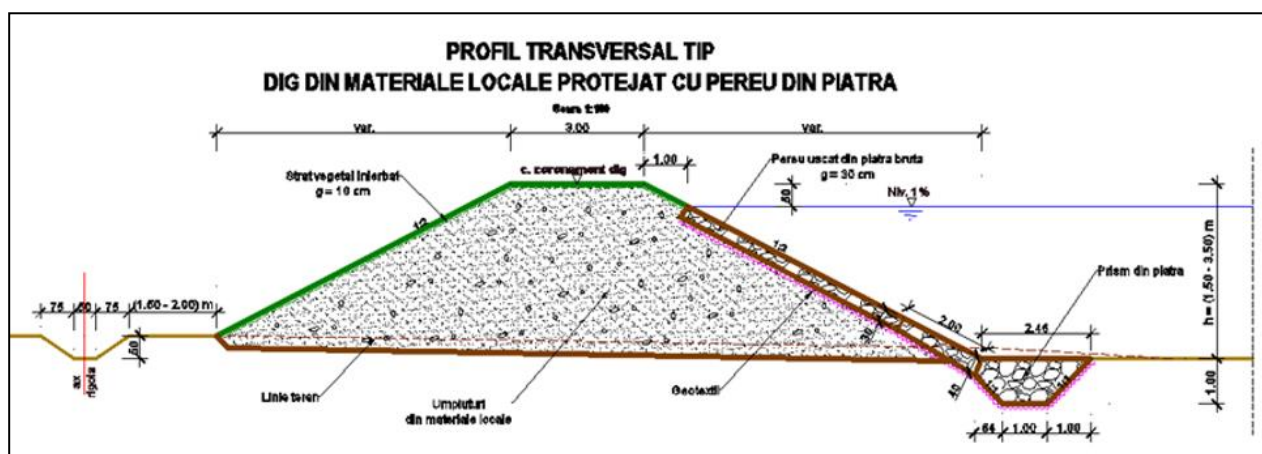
Profil transversal dig materiale locale protejat cu pereu din piatră
